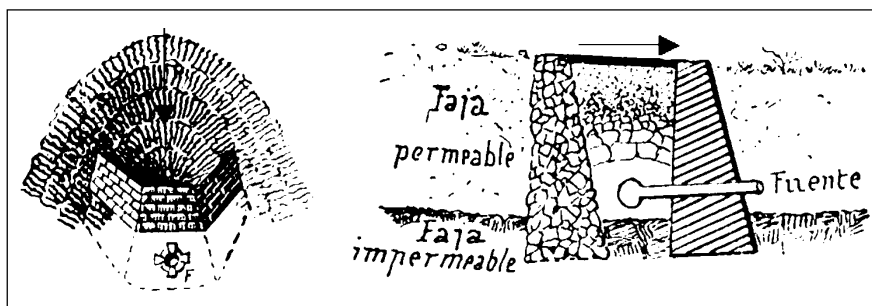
Dos tipos de presas subálveas: a) Presa de un sólo muro. b) Presa de dos muros.
